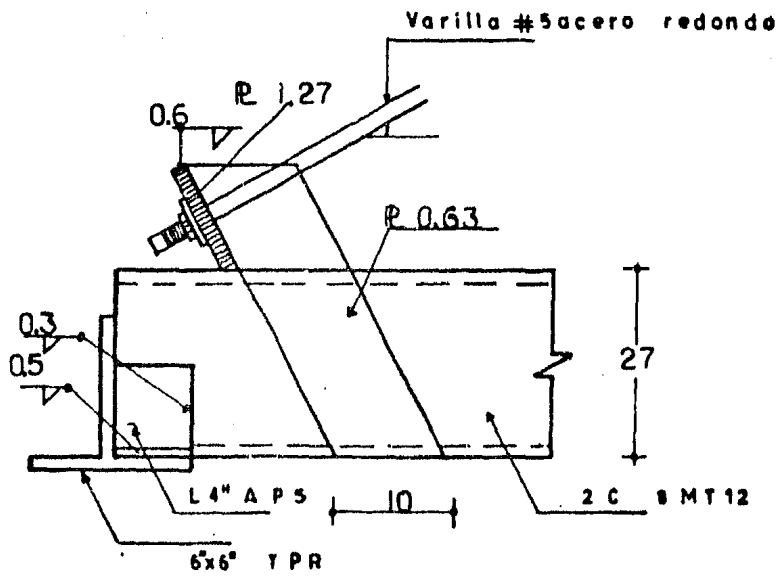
Detalle de conexión de contraventeos verticales y horizontales.
